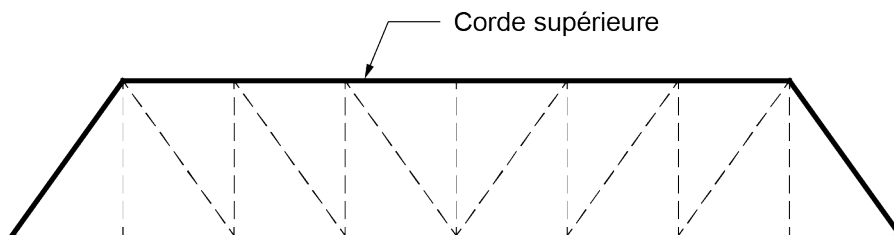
Corde supérieure d'une poutre triangulée
